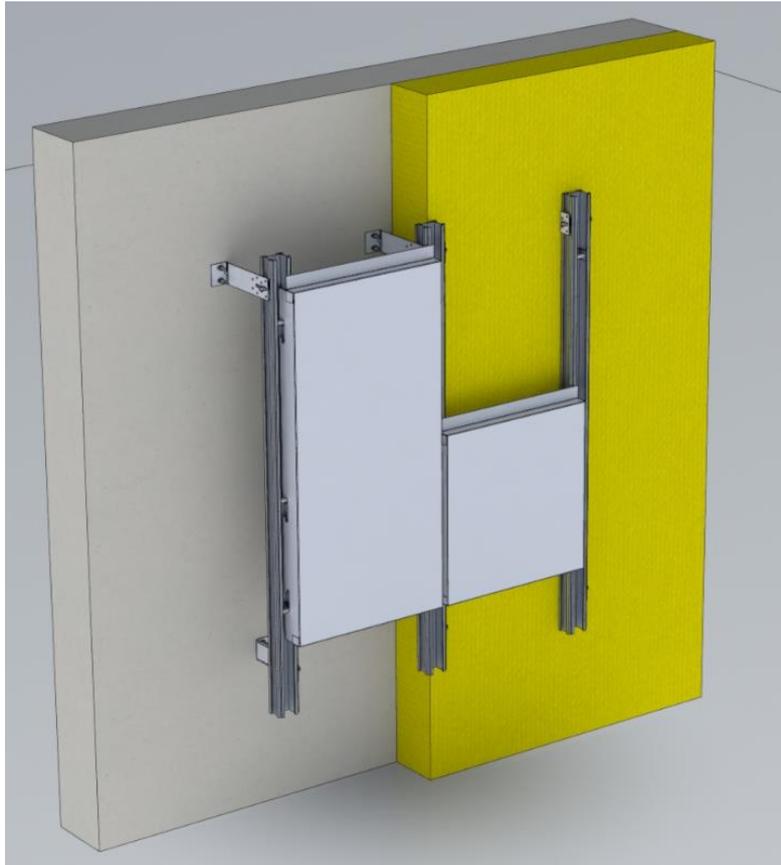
Système ISOPLING 36 sur Maçonnerie
